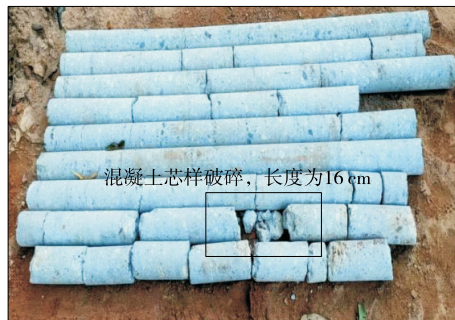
距 2[#] 声测管 10 cm 位置的混凝土芯样
